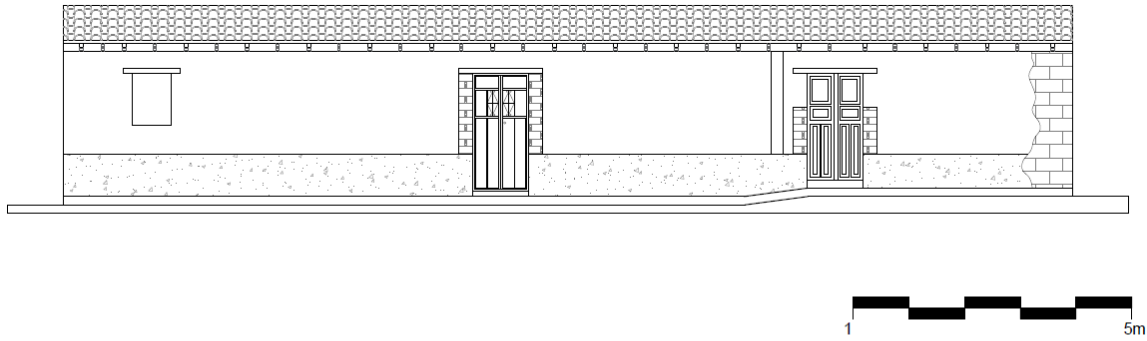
Vivienda SLJ008, construcción de adobe y techo de teja.
